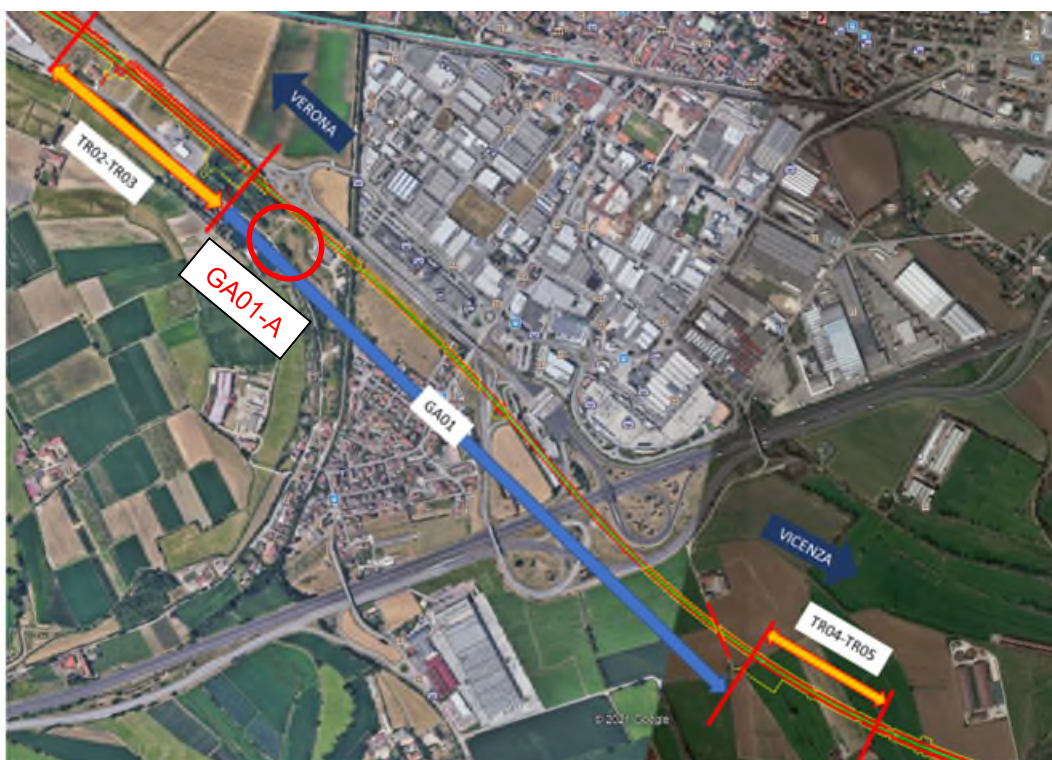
Planimetria di inquadramento galleria artificiale GA01 e trincee
